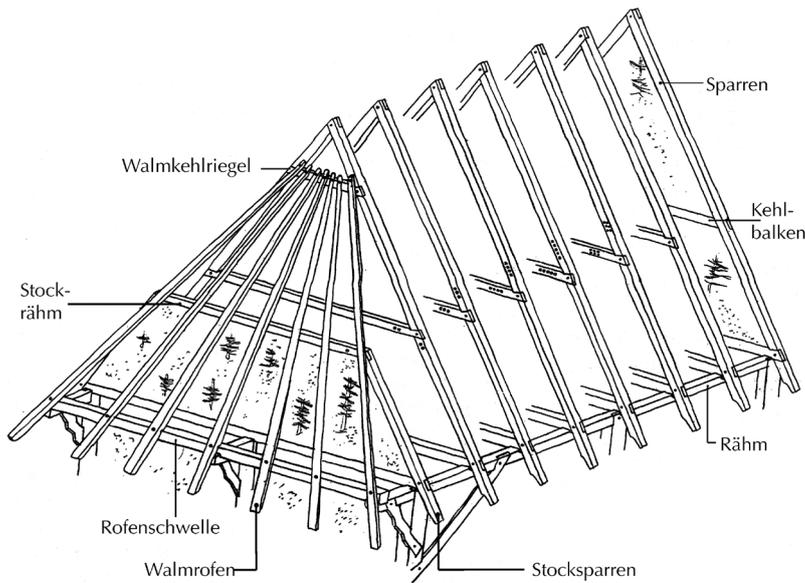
Satteldach mit Vollwalm und Giebelabschluss.
